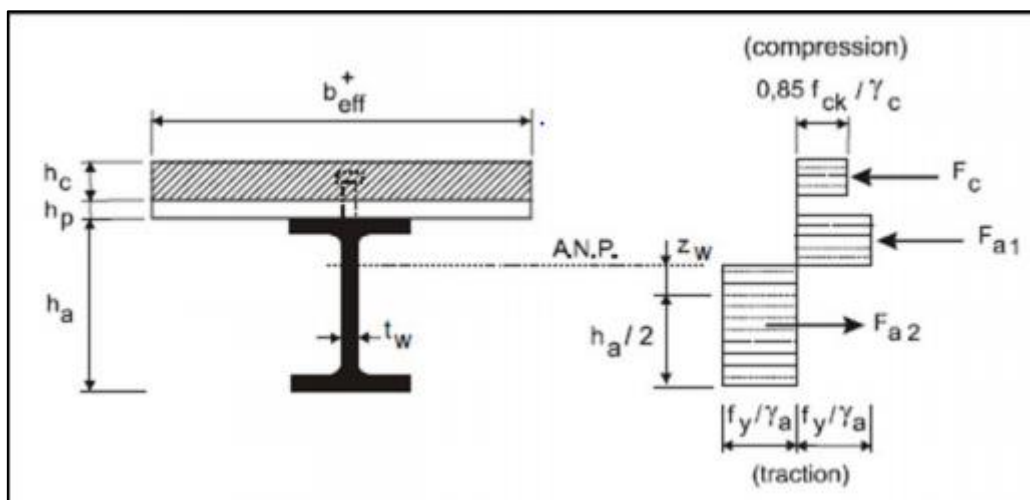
Comportement plastique d'une poutre mixte connectée
